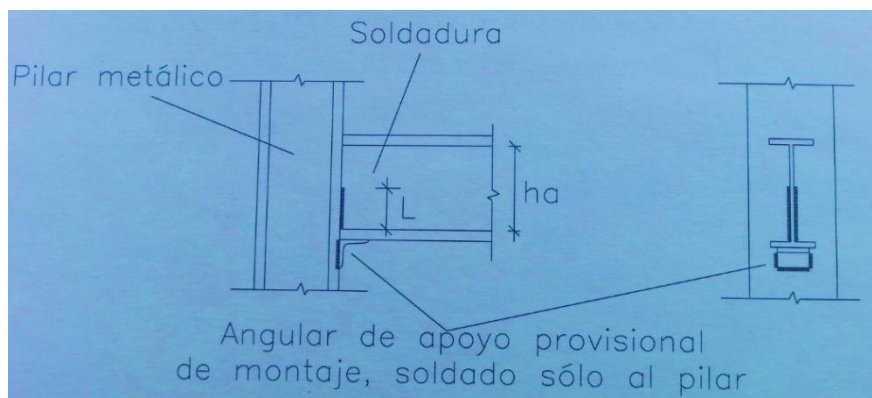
ejemplo unión articulada con soldadura Fuente: Libro "Construcción de Estructuras Metálicas"
